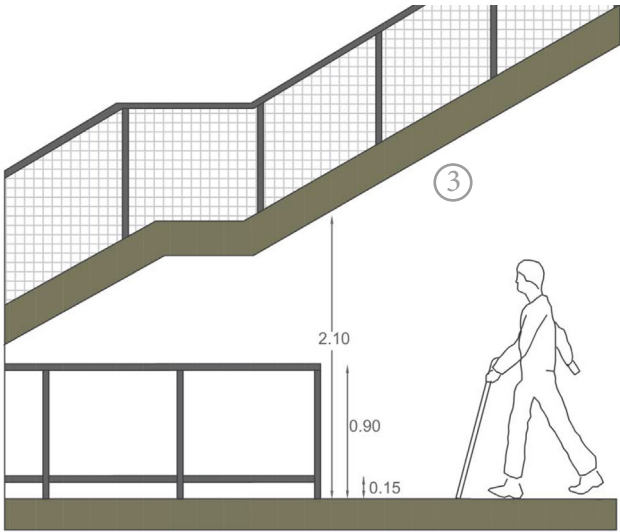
3 Circulación bajo elementos - Alzado
